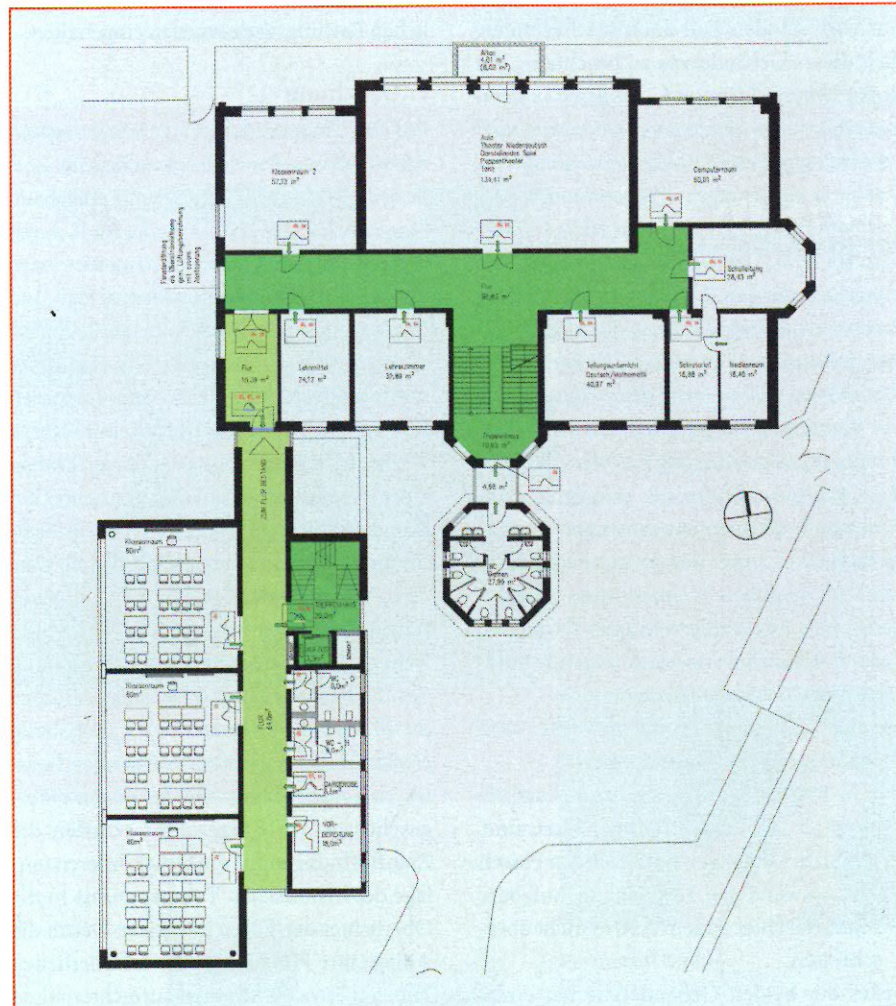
Grundriss erstes Obergeschoss Altbau und zweites Obergeschoss Neubau
